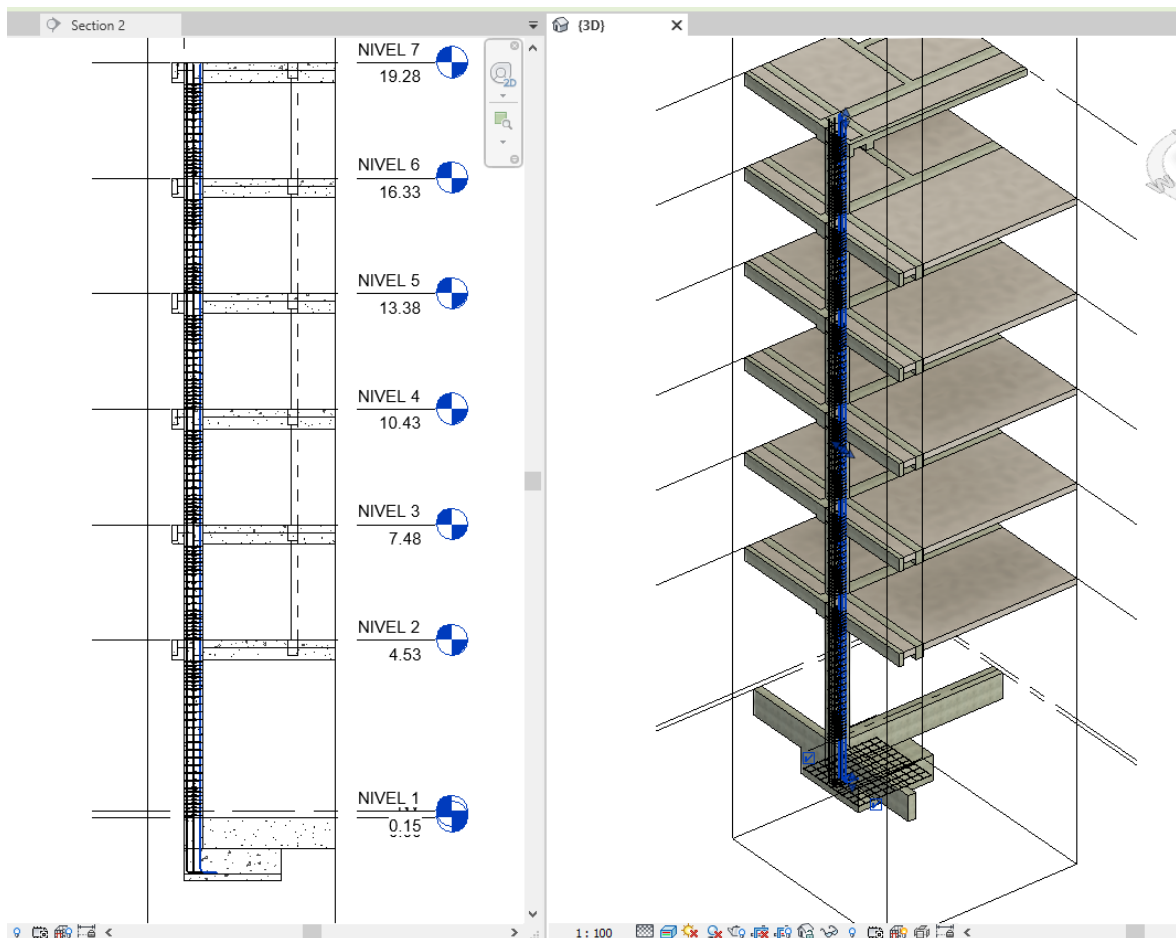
Vista Corte y 3D de distribución de acero en Columna C-1 (Fuente: Elaboración Propia).
